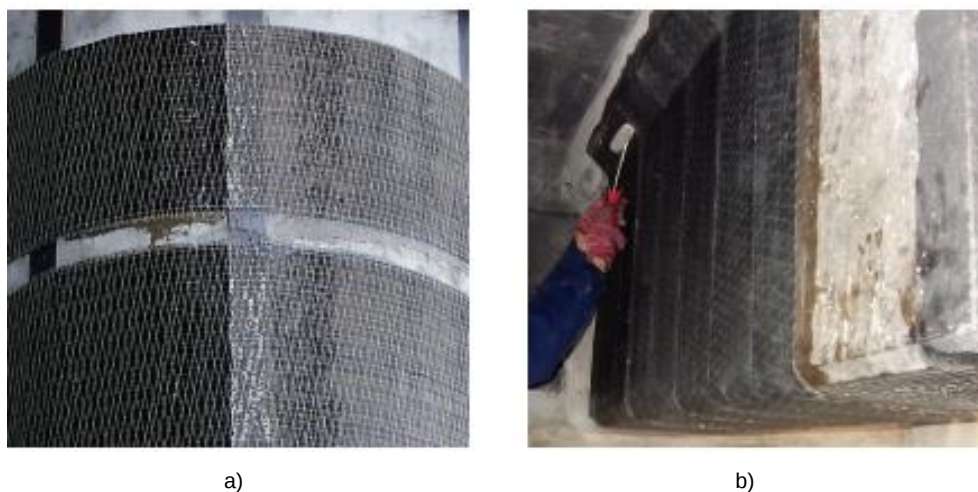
Técnica de cintagem com manta em FRP a) pilar, b) viga (S&P, 2021).
